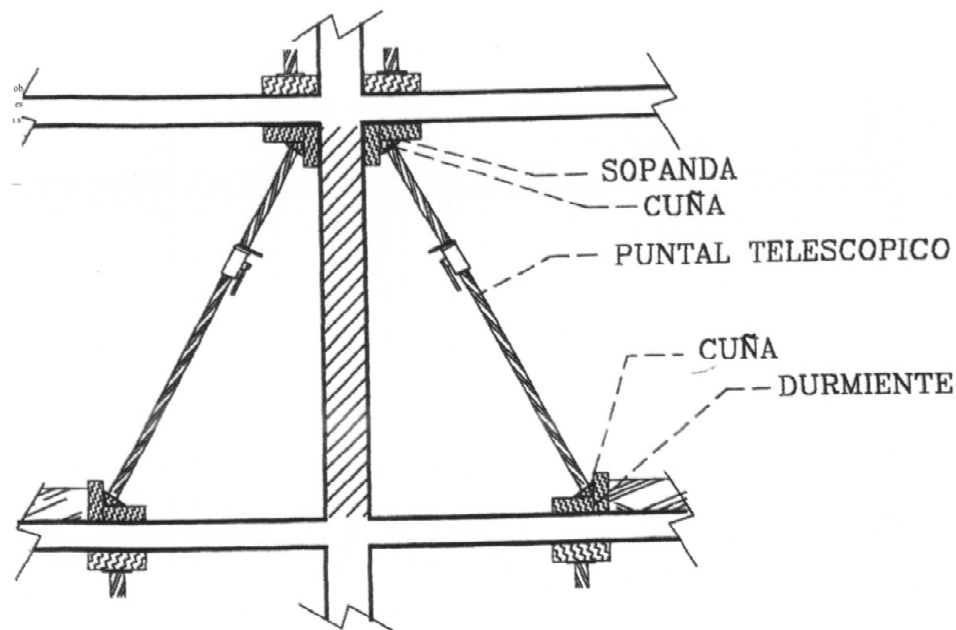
Apeo de pilar mediante puntales telescópicos
